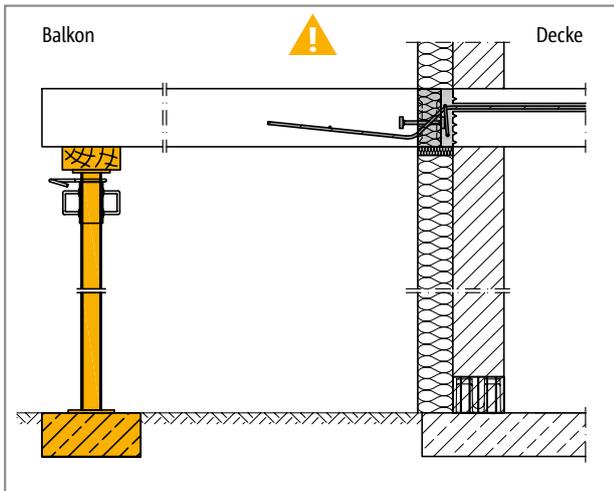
Schöck Isokorb® RT Typ QP: Stützung durchgängig erforderlich
